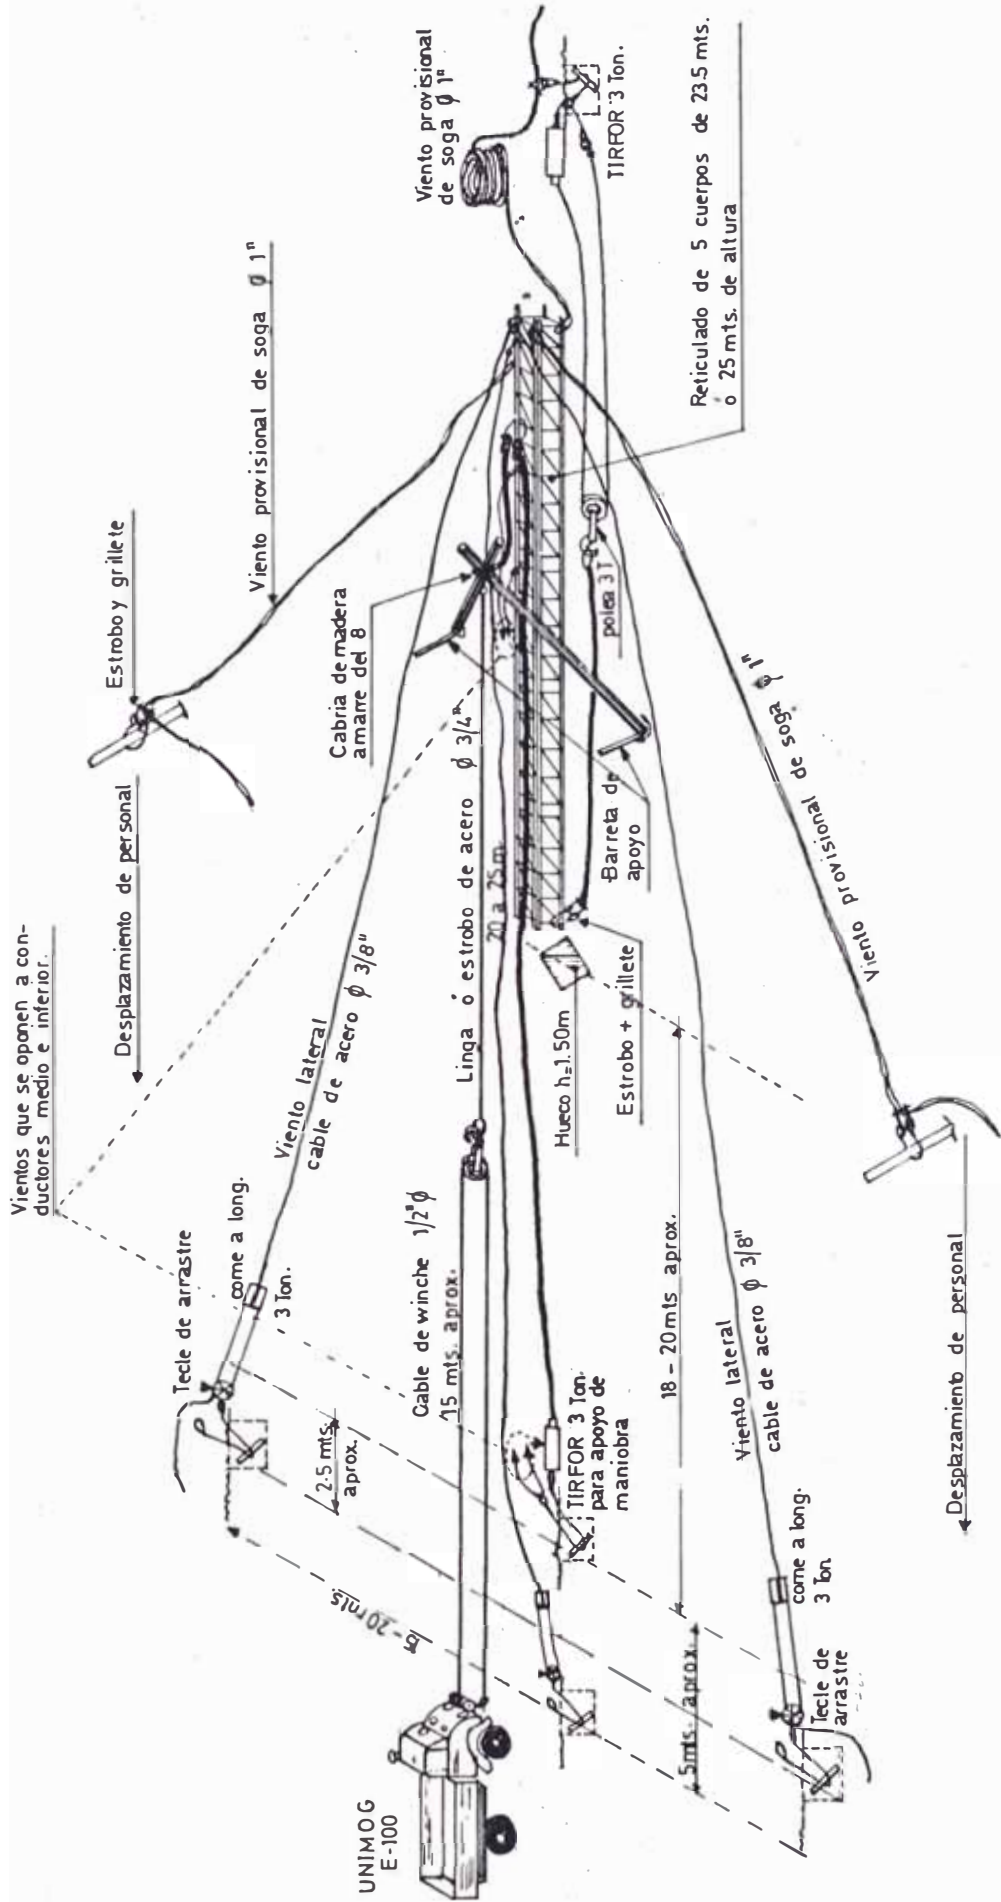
DISPOSICION DE MANIOBRAS PARA IZADO DE RETICULADO
